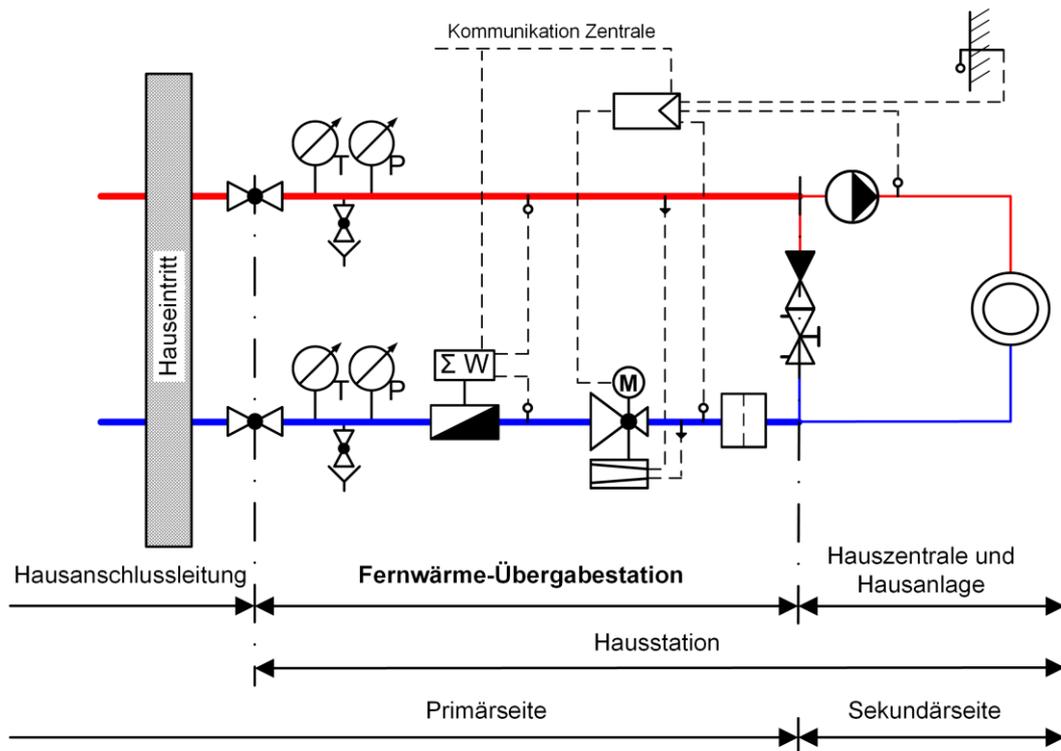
Hausanschluss mit direkter Wärmeübergabe.
